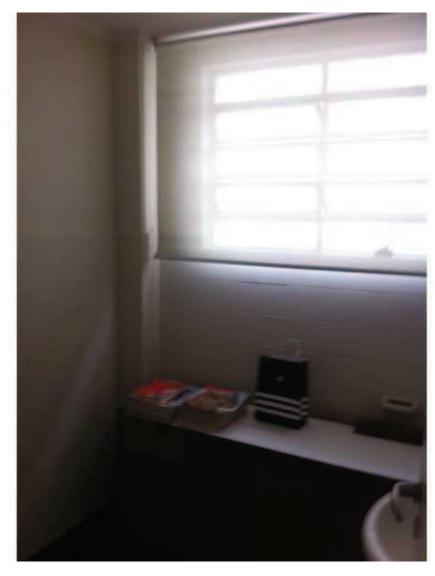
Banheiro da unidade, também em bom estado de conservação. Azulejos originais foram pintados.
